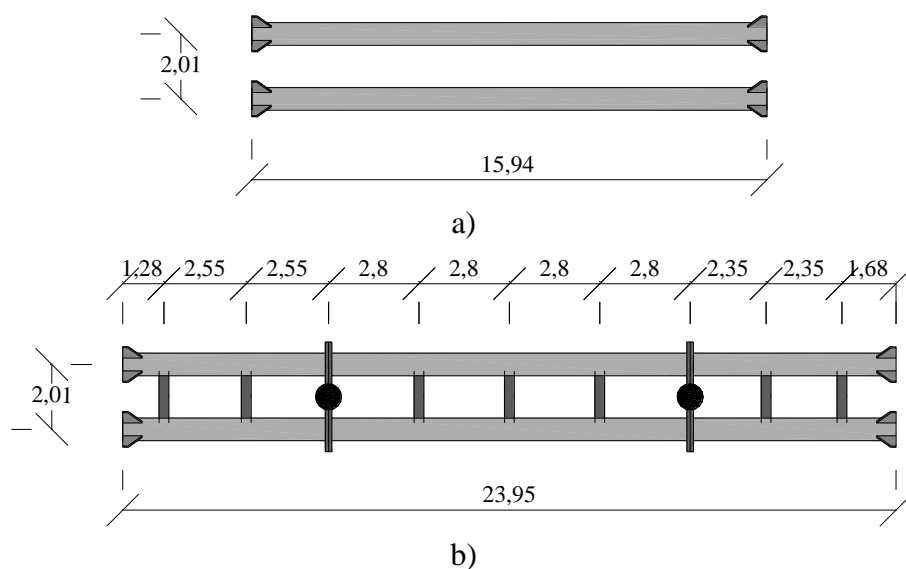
Dimensões das escoras metálicas usadas: a) zona estreita; b) zona larga
